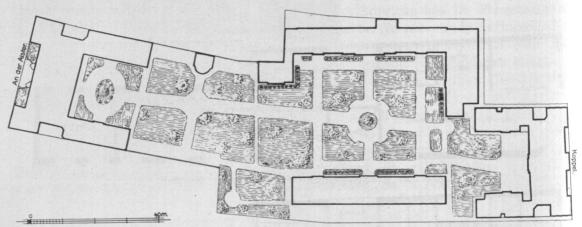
Auguft-Beerlein-Stift, Lageplan.
